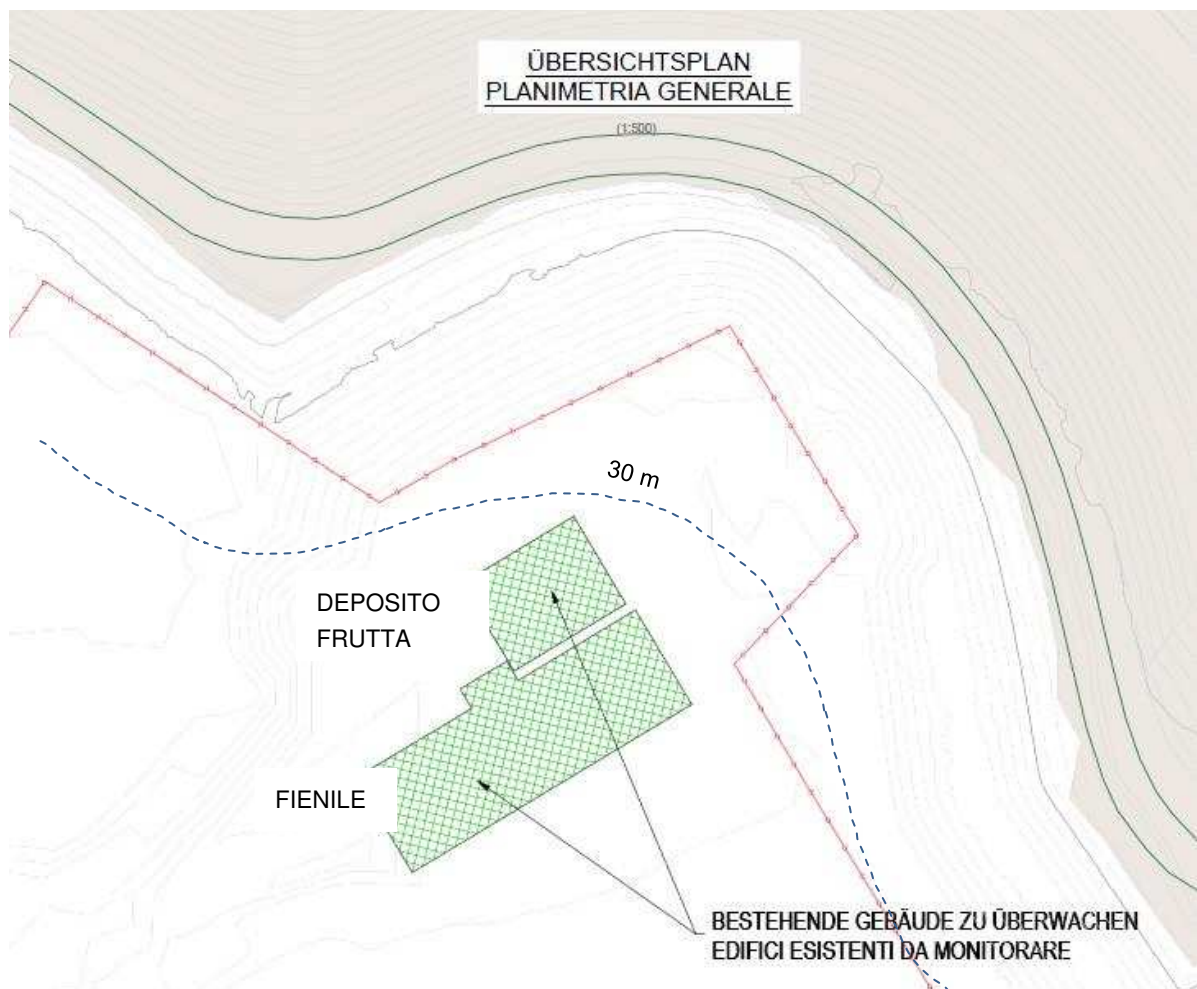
Detailplan der vorhandenen Gebäudefläche (Scheune und Lagerung)
